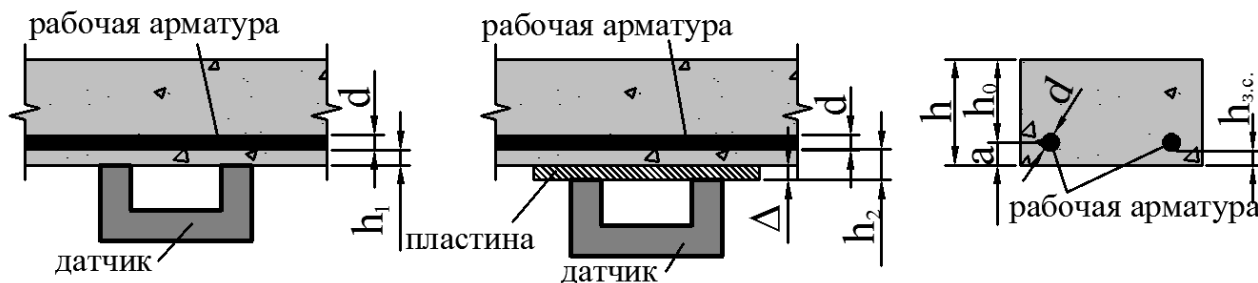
Схема определения диаметра арматуры и величины защитного слоя бетона железобетонной балки
